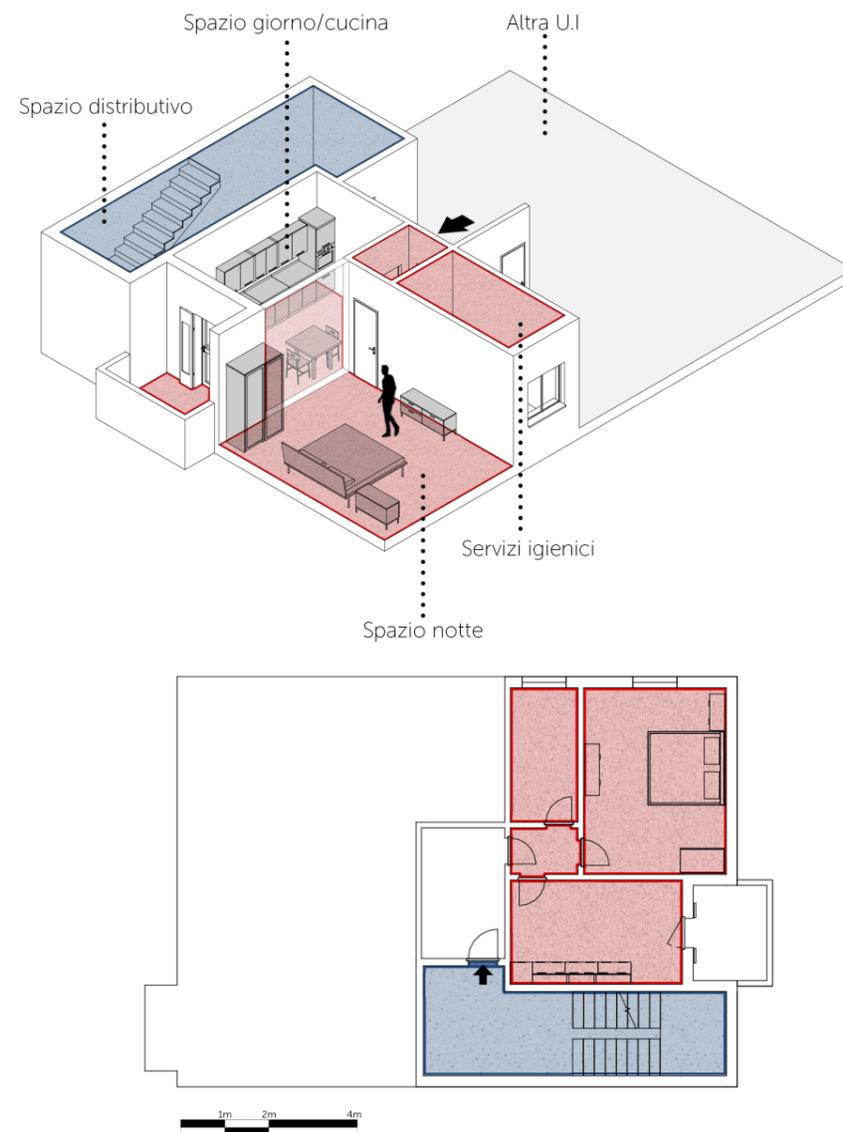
Vista 3D e pianta della disposizione interna del secondo nuovo appartamento
